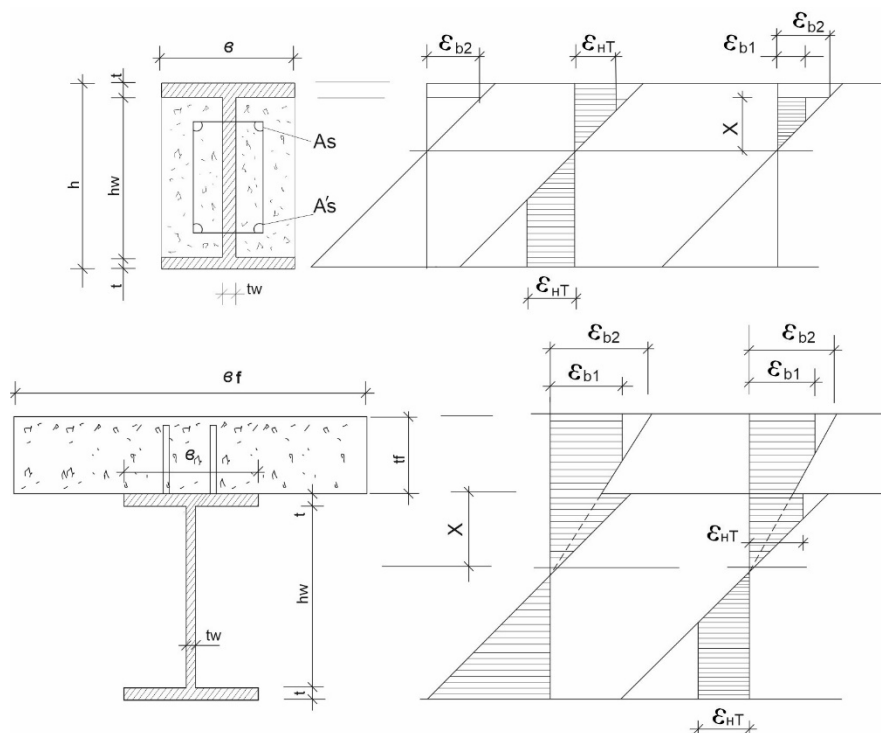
Расчетная схема сечений на основе предельной относительной деформации сжатия бетона:
